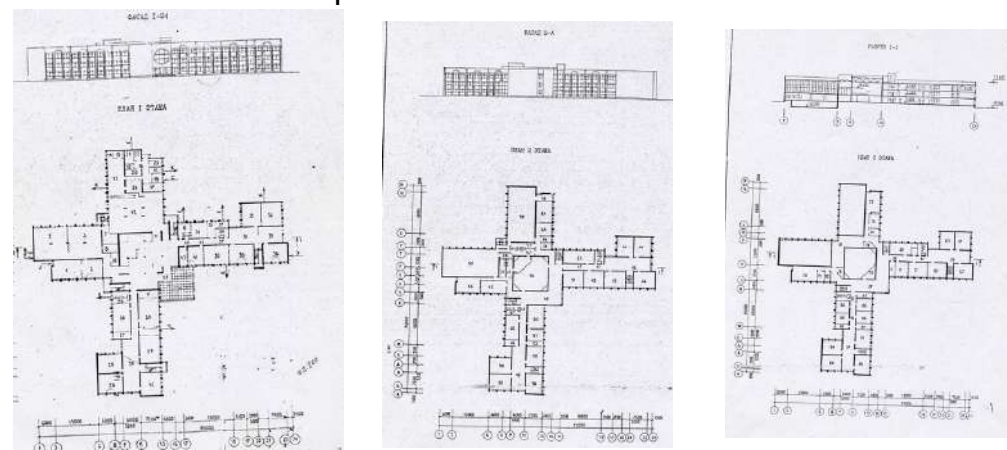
Фасади,розрізи ,плани проекту школи.
